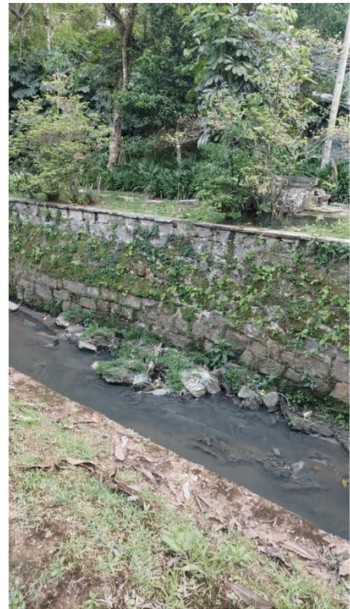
Foto do canal Museu do artesanato do Estado do Rio de Janeiro
